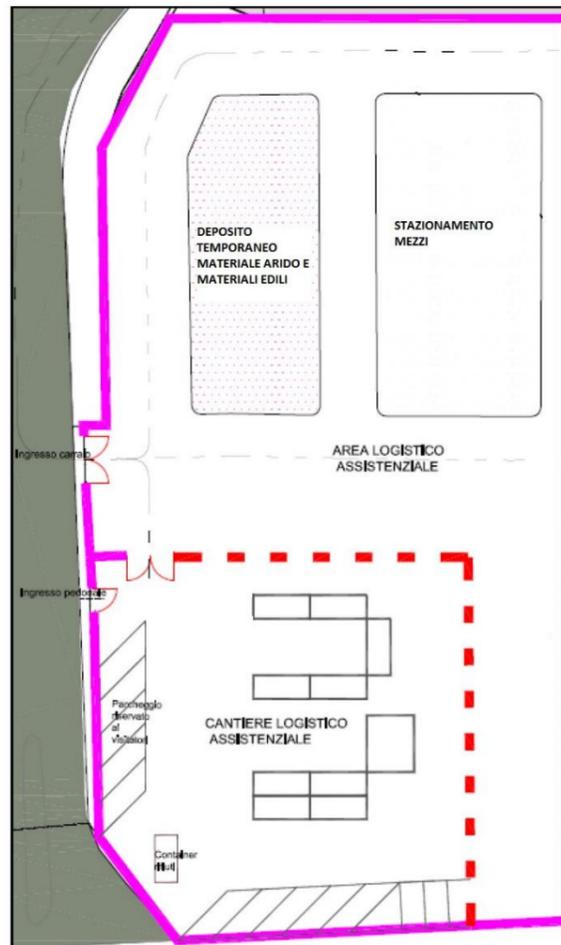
Schema tipo del cantiere logistico – Fasi 2 e 3 PSA.
